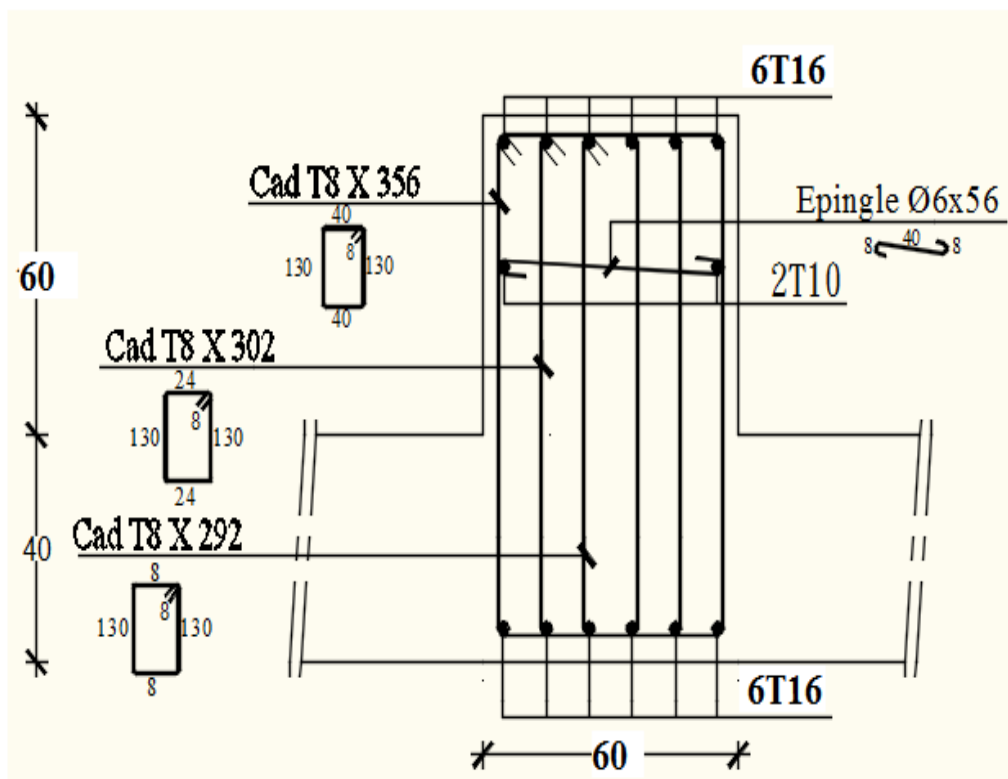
dessin de ferrailage d'une poutre secondaire en travée.
